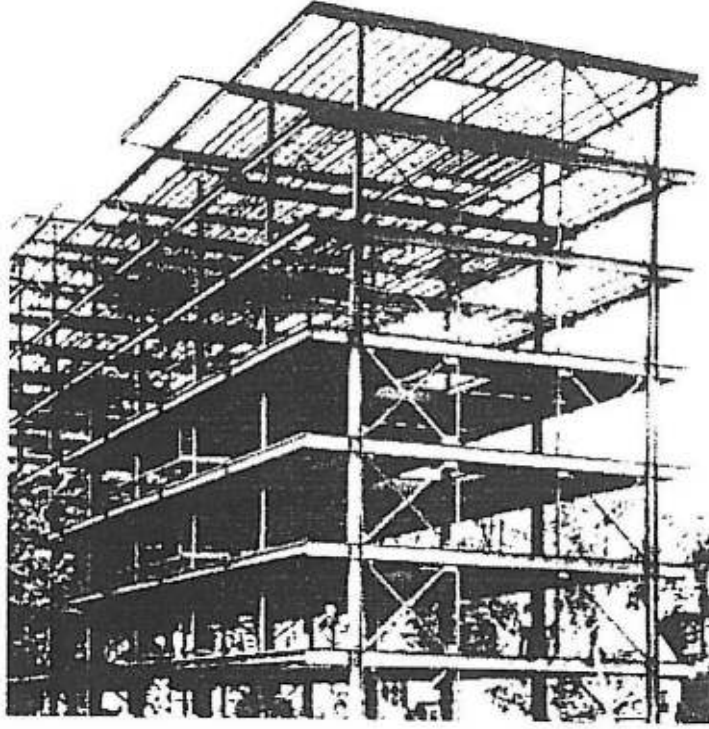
Woolworth Tower Binası New York 1913.(Tall, 1964)
